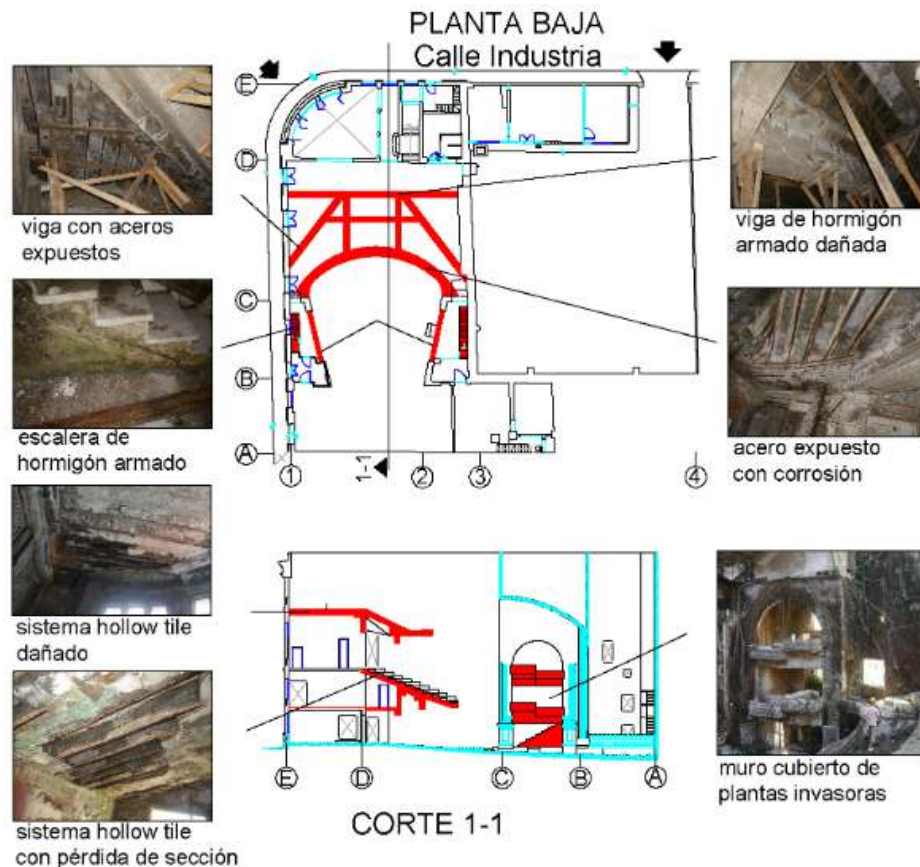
Deterioro avanzado de daños por corrosión en las vigas de hormigón armado, los aceros del sistema hollow tile y los refuerzos de las escaleras. Los muros interiores se muestran colonizados por raíces y musgos.
